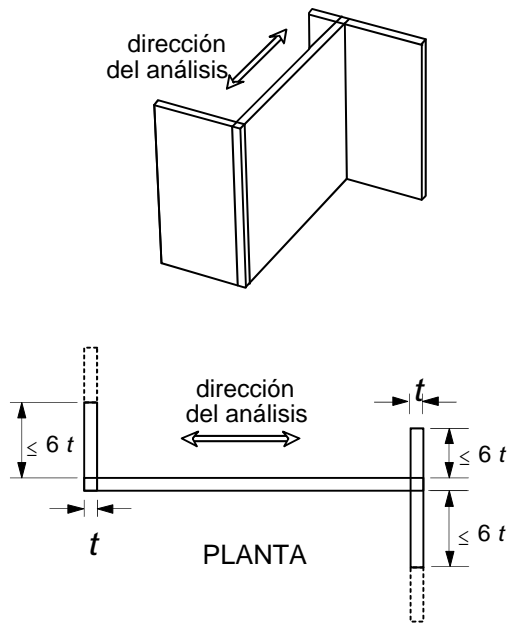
Ancho del patín a compresión en muros I, T, C o L
